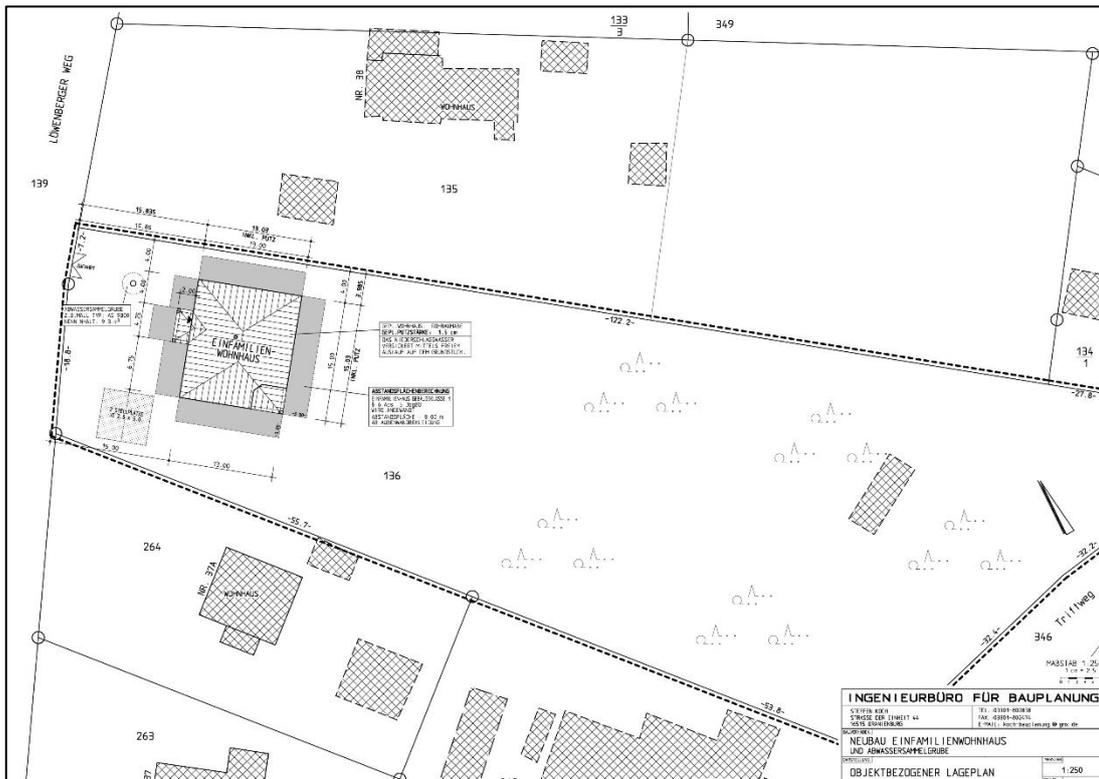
Ausschnitt aus dem objektbezogenen Lageplan für den geplanten Neubau eines Einfamilienhauses am Löwenberger Weg (Ingenieurbüro für Bauplanung Steffen Koch, 16515 Oranienburg)
